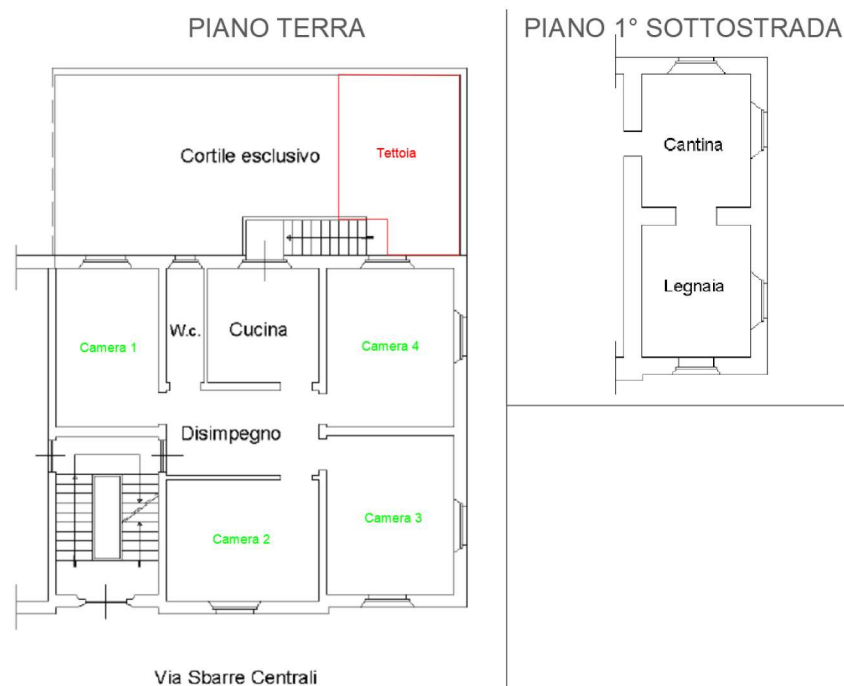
Planimetria dell'appartamento (e delle relative pertinenze) oggetto di pignoramento, con individuazione dei locali
